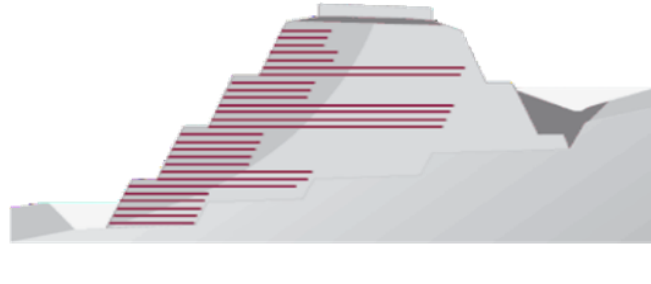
35: Renforcement par tirant sur l'autoroute A 41,(Haute-Savoie).
